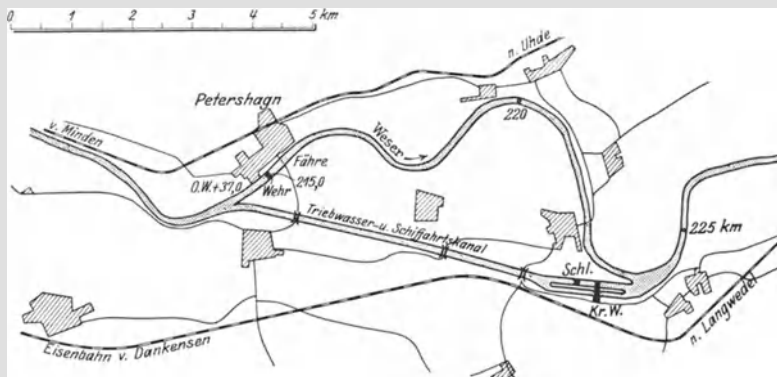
Petershagen. Lageplan. Maßstab 1 : 125 000.
